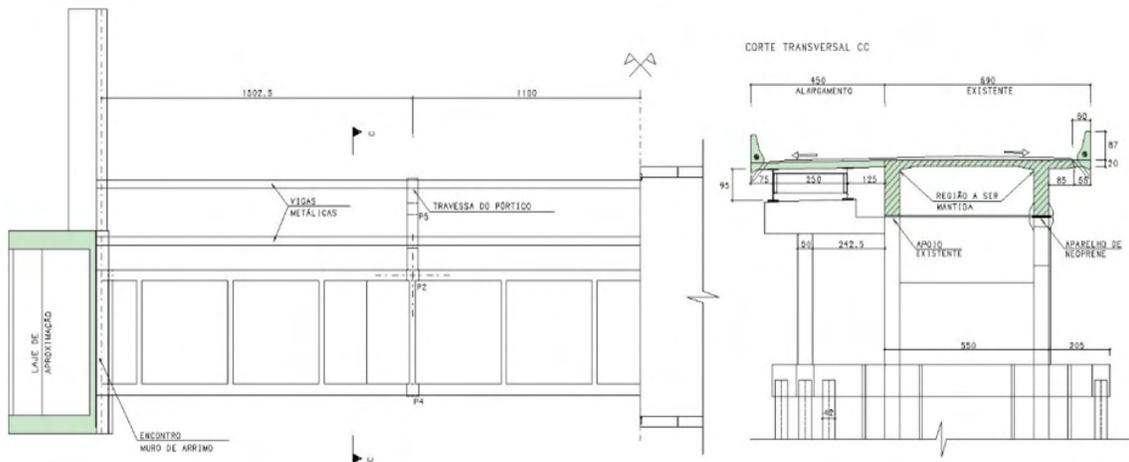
Cortes Horizontal e Transversal do Alargamento.
